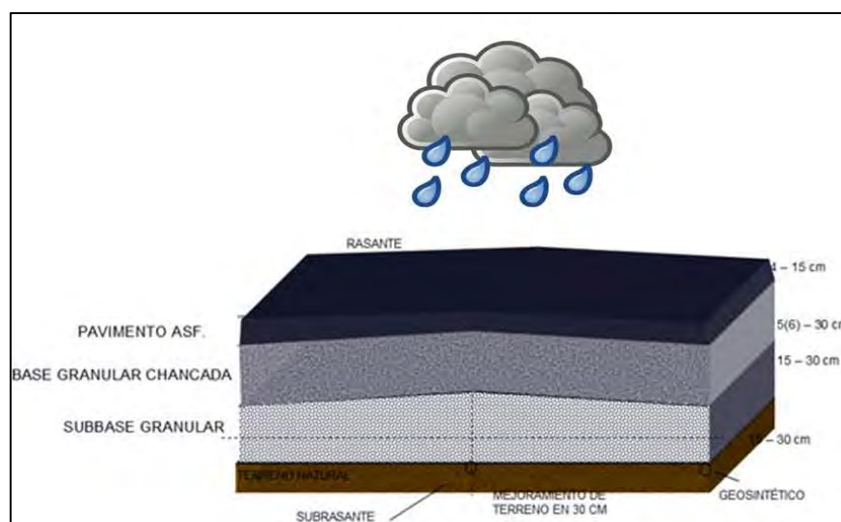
Corte Transversal Tipo de un Pavimento Flexible bajo la Lluvia
